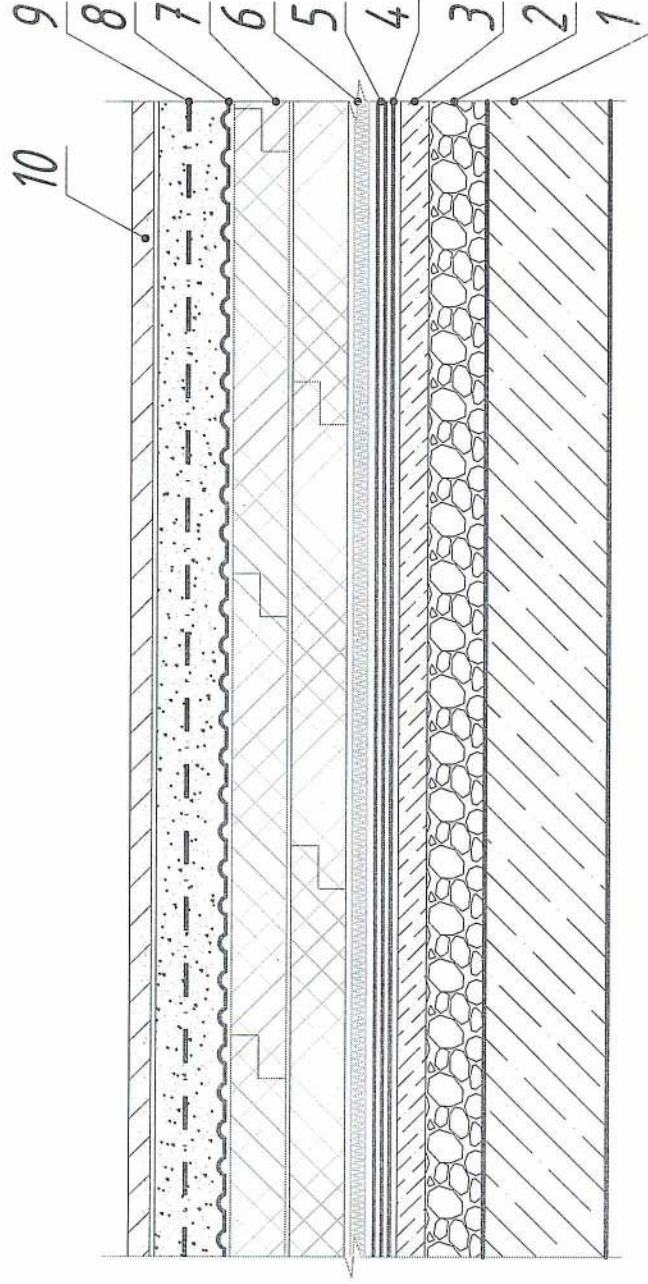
Принципиальная схема конструктивного исполнения бесчердачного покрытия выполняемого по железобетонному основанию (инверсионная эксплуатируемая кровля под автомобильную нагрузку)
